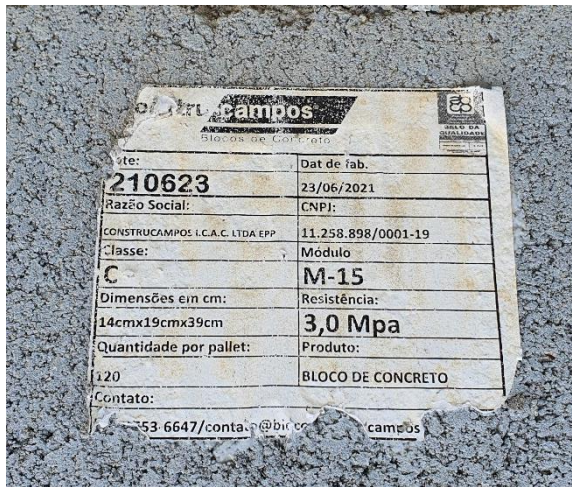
Etiqueta com informação do tipo de bloco de concreto utilizado.
